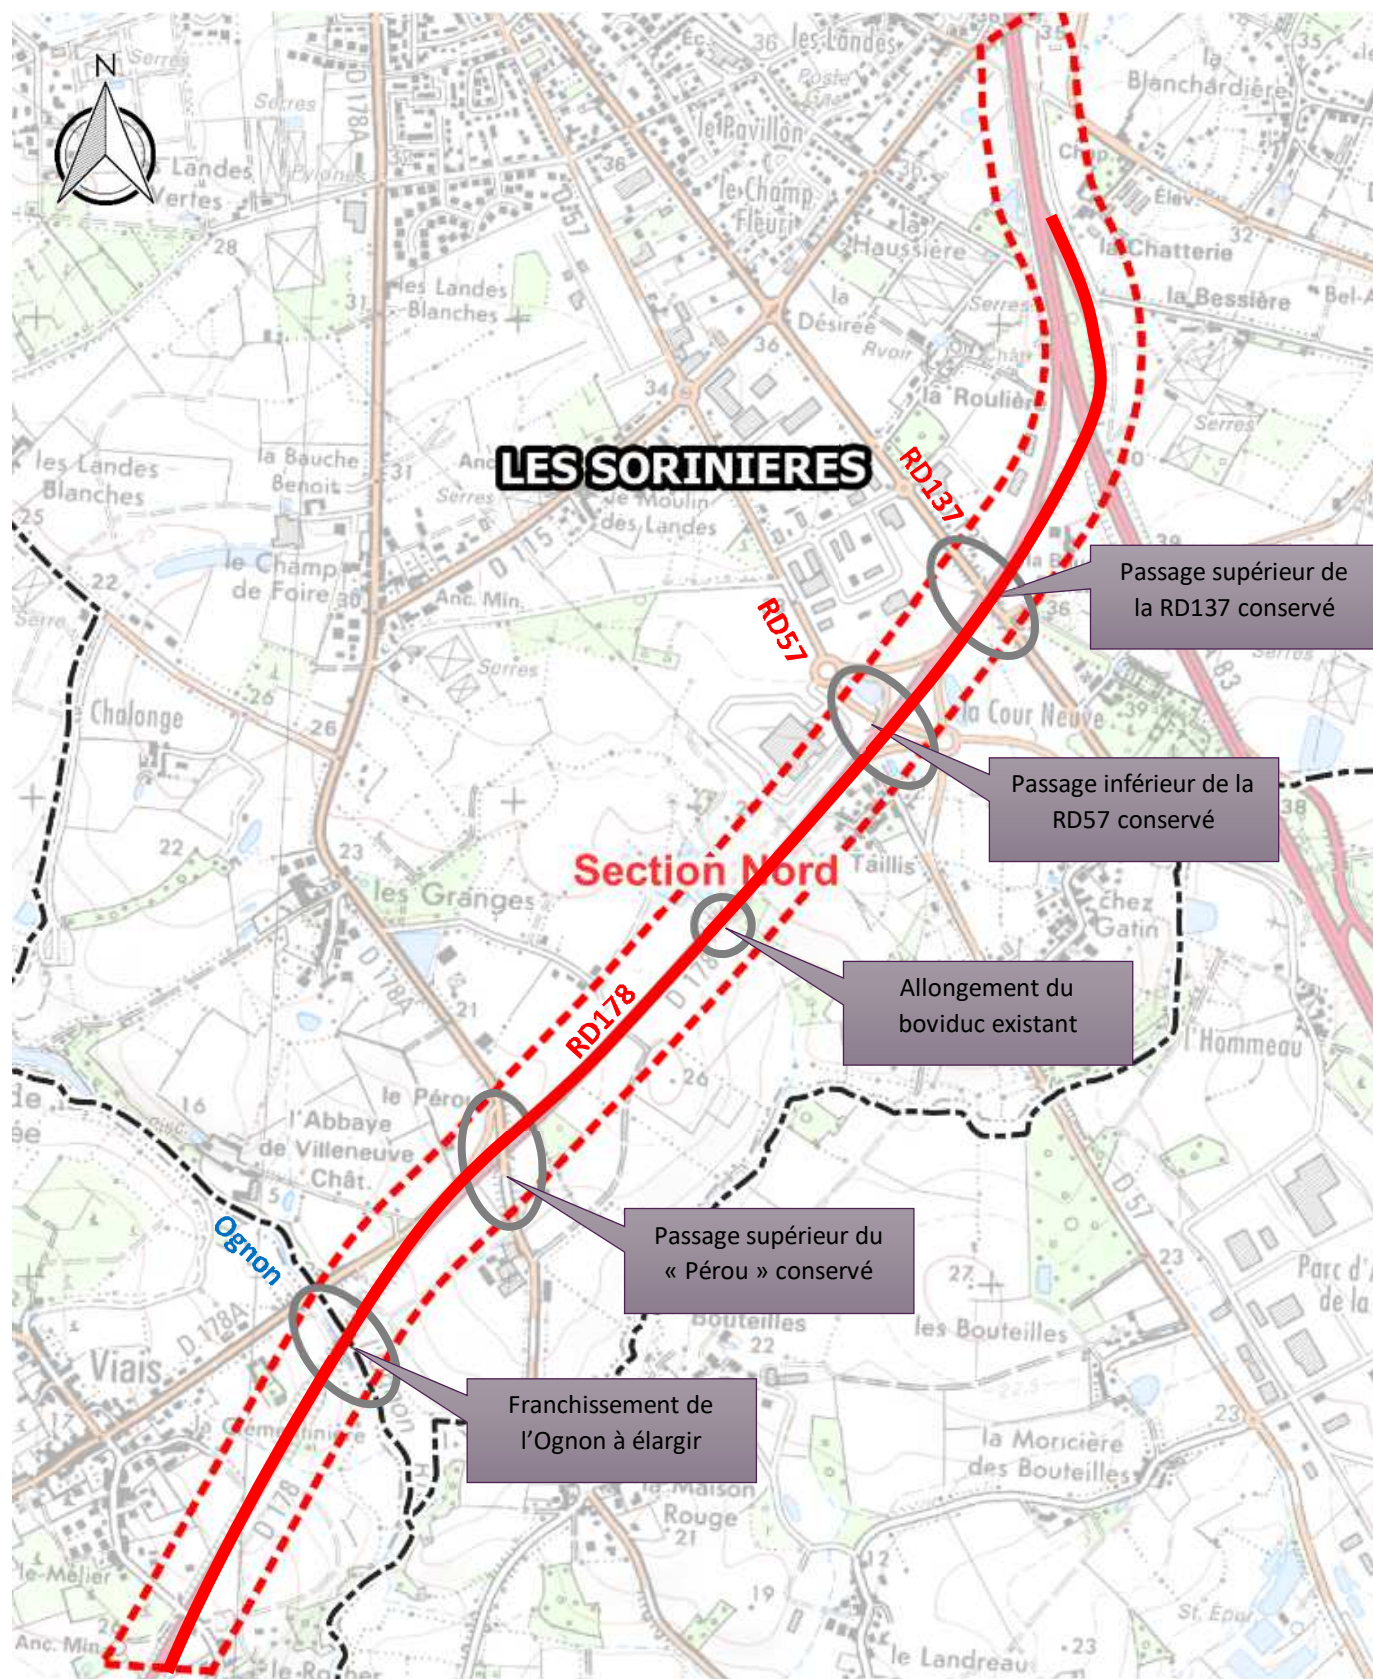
Localisation des ouvrages d'art à franchir sur la section Nord
